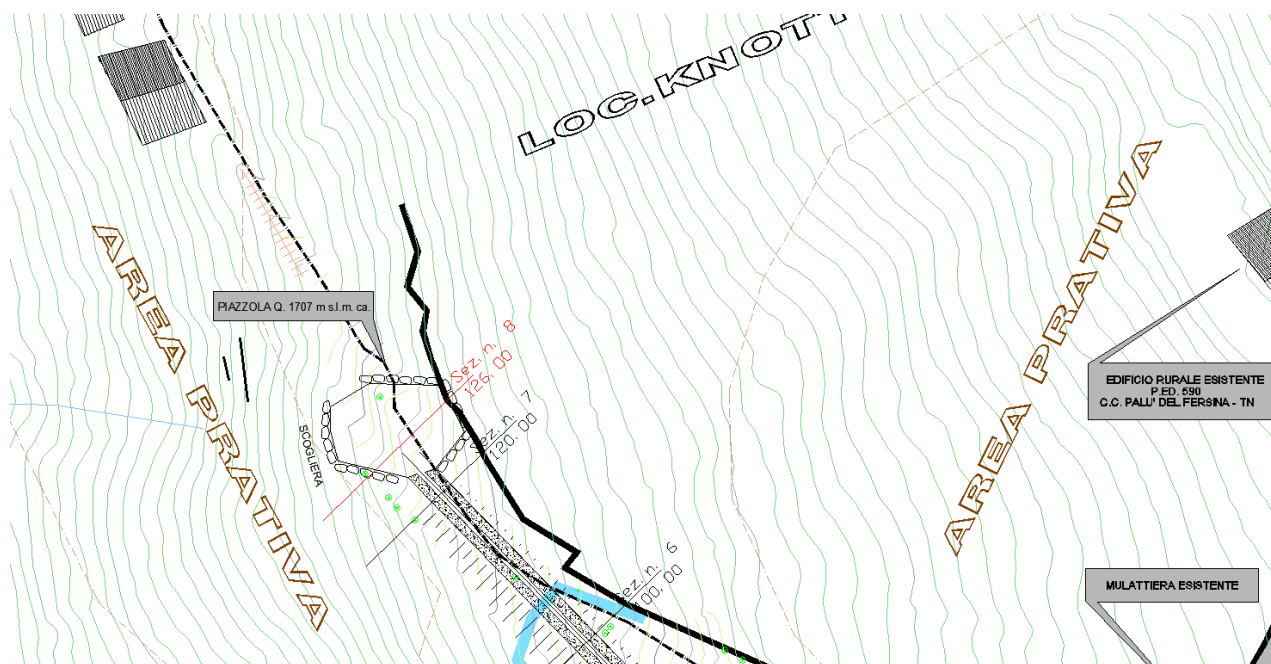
Loc. Knottler - SEZ. 8 - UBICAZIONE TRACCIA SEZIONE DI CALCOLO GEOTECNICO
